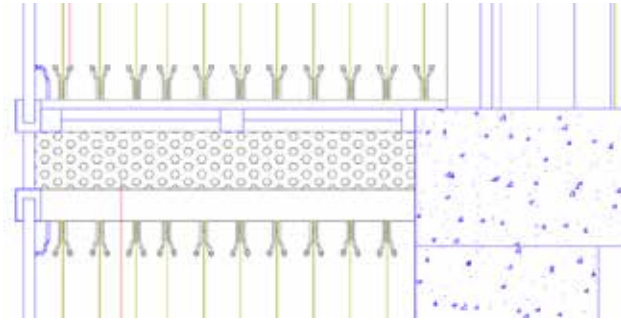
Detalle de Corte del sistema estructural y de ventilación de la Fachada de doble vidrio. (2017).
